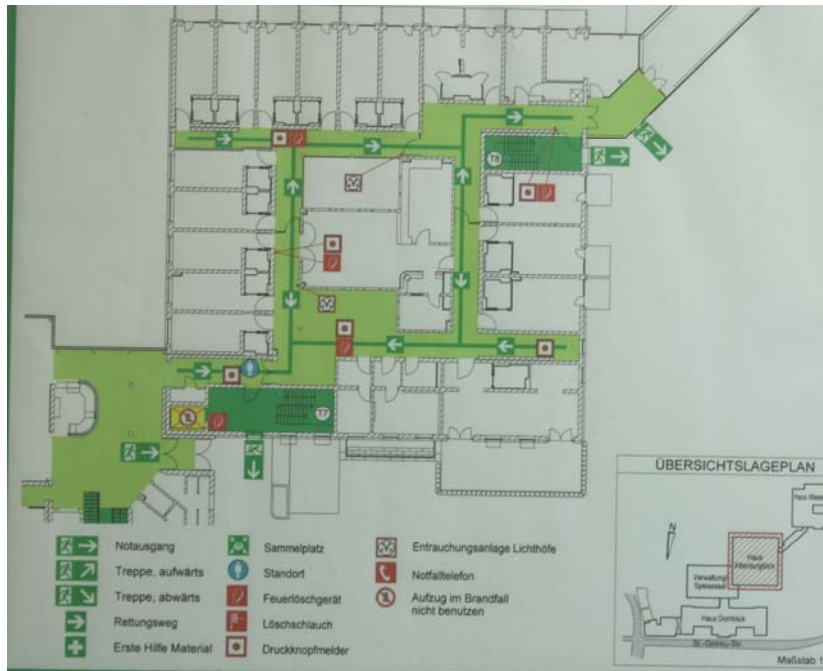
Grundriss Pflegeoase unten rechts
